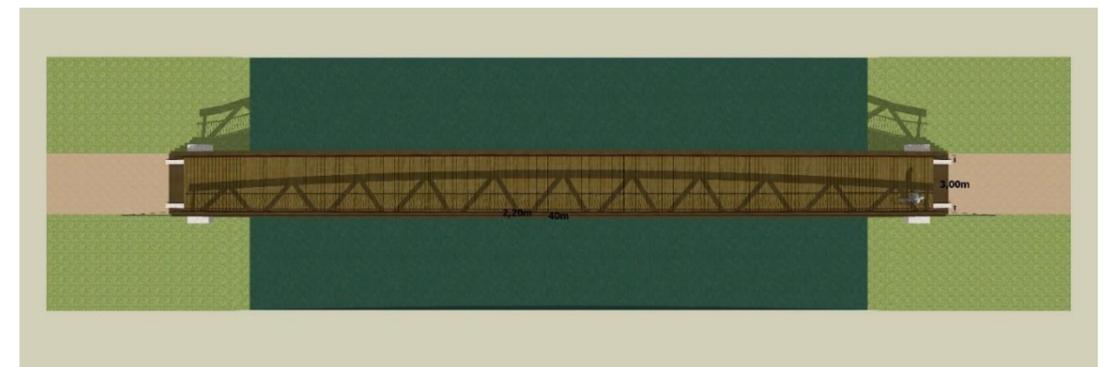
La vue en Plan d'une passerelle avec escaliers d'accès
